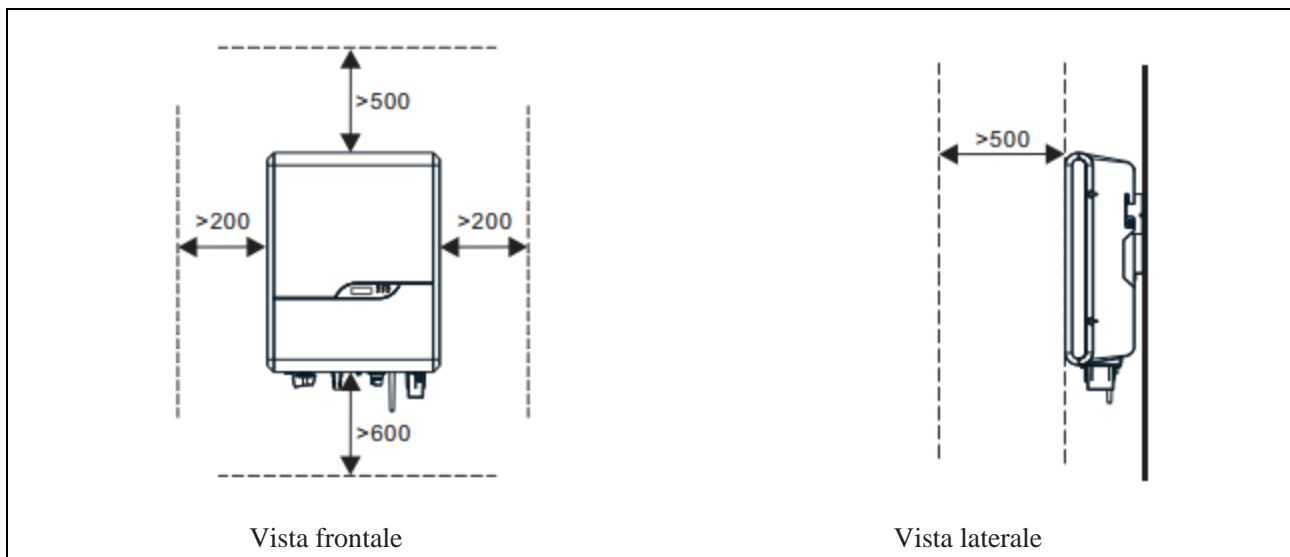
Requisiti di spazio per l'installazione (unità: mm)
